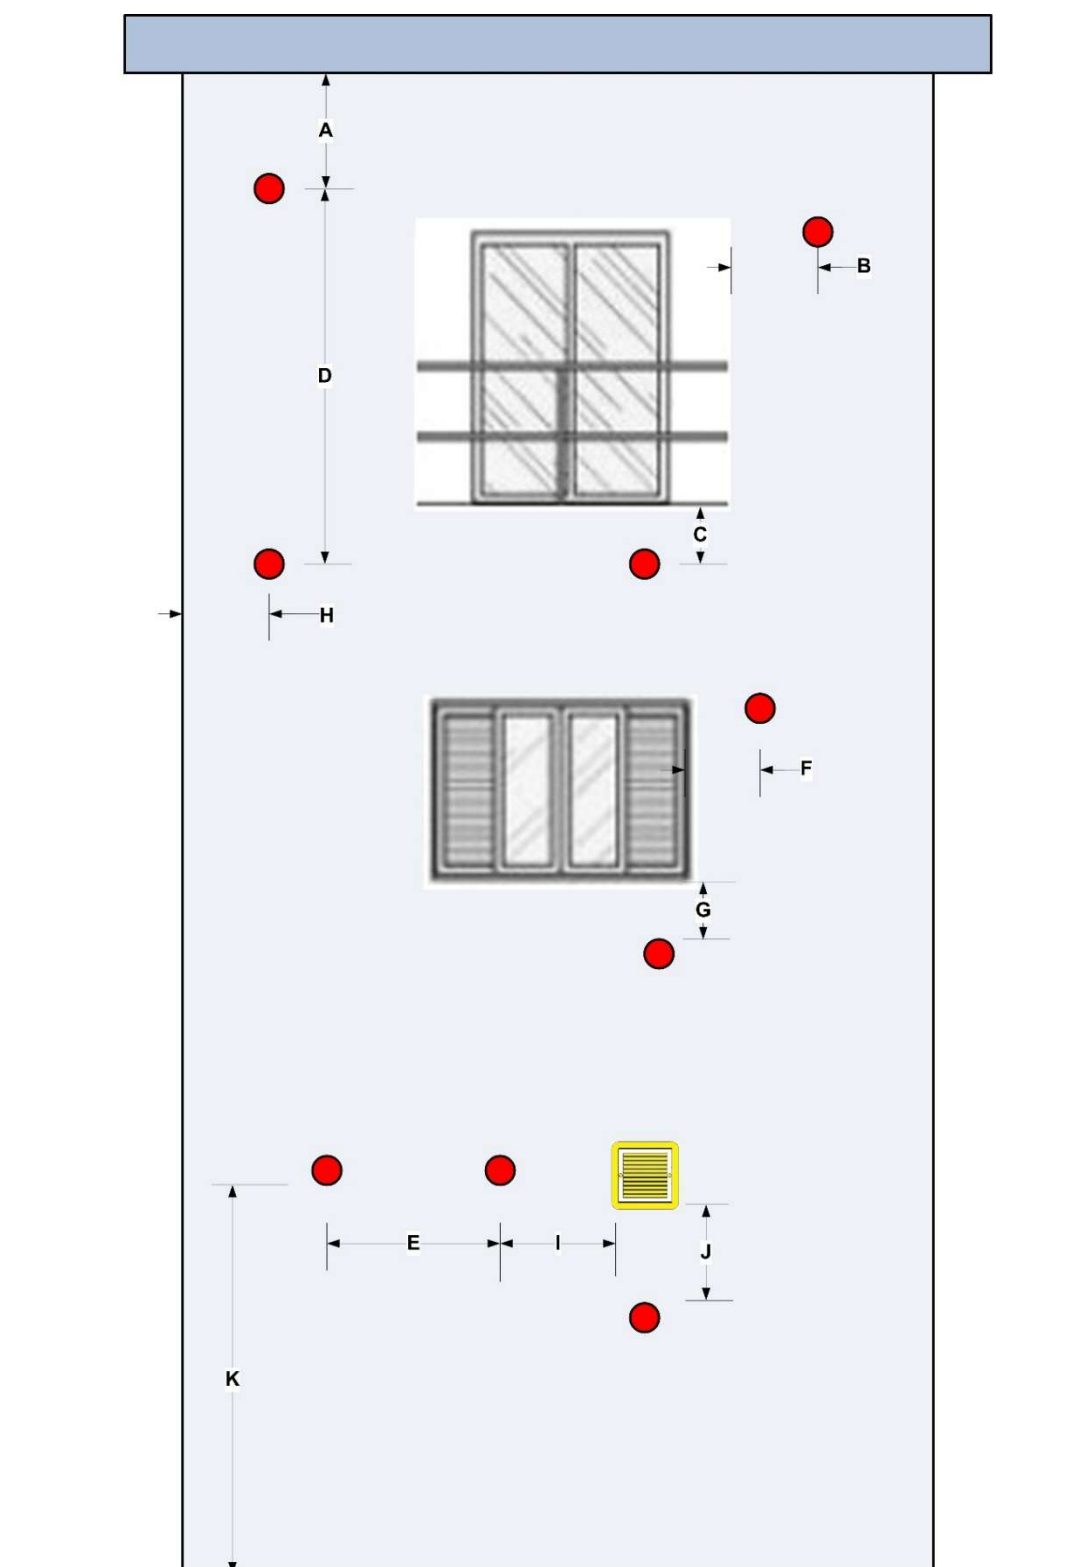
i. Afastamentos entre terminal da chaminé para exaustão para abertura para ventilação do ambiente, janela, balcão, piso, beiral e exaustão.
